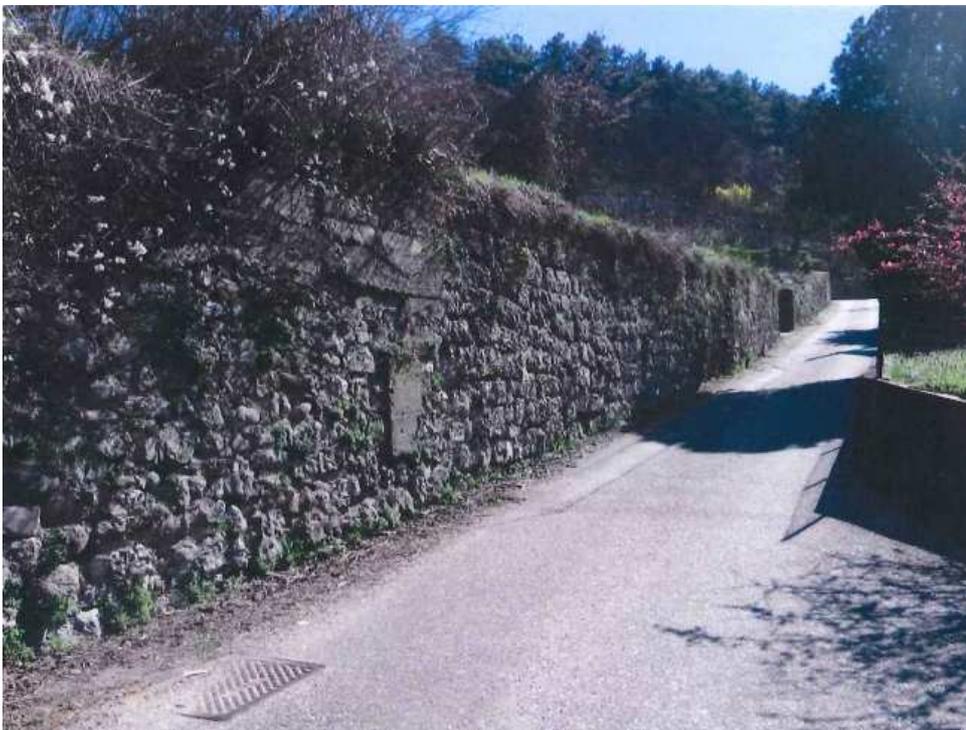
Muro in demolizione (p.f. 44/1) e restringimento stradale oggetto di allargamento
